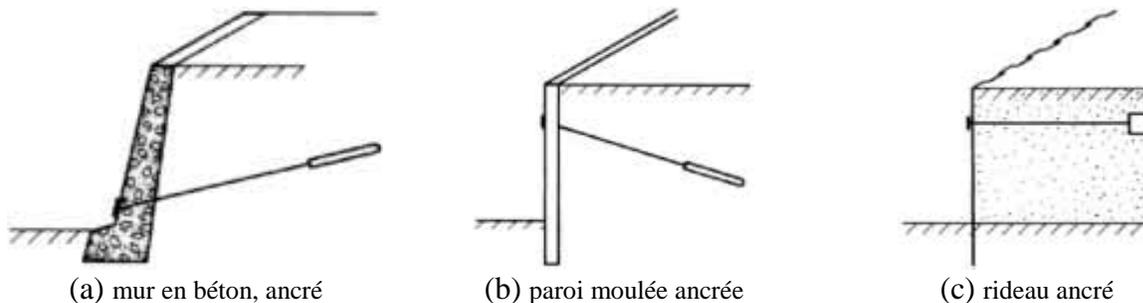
Type d'ouvrages de soutènement - poussée reprise par ancrage
